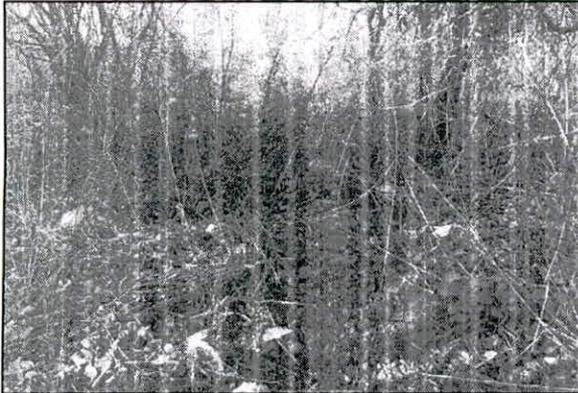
y 2 Área donde se construirá el viaducto con estructura metálica para paso elevado de la tubería
